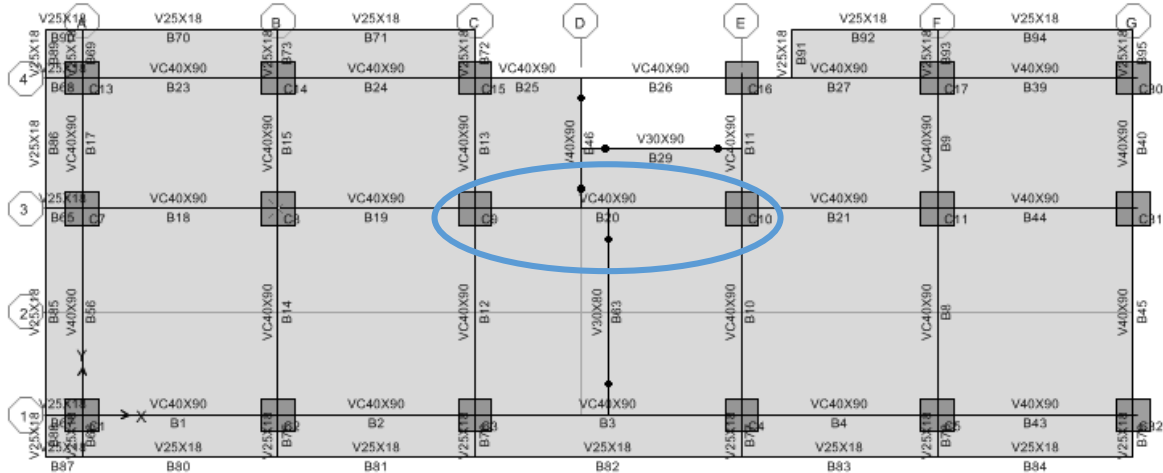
Planta del modelo matemático 01 (Fuente propia).
